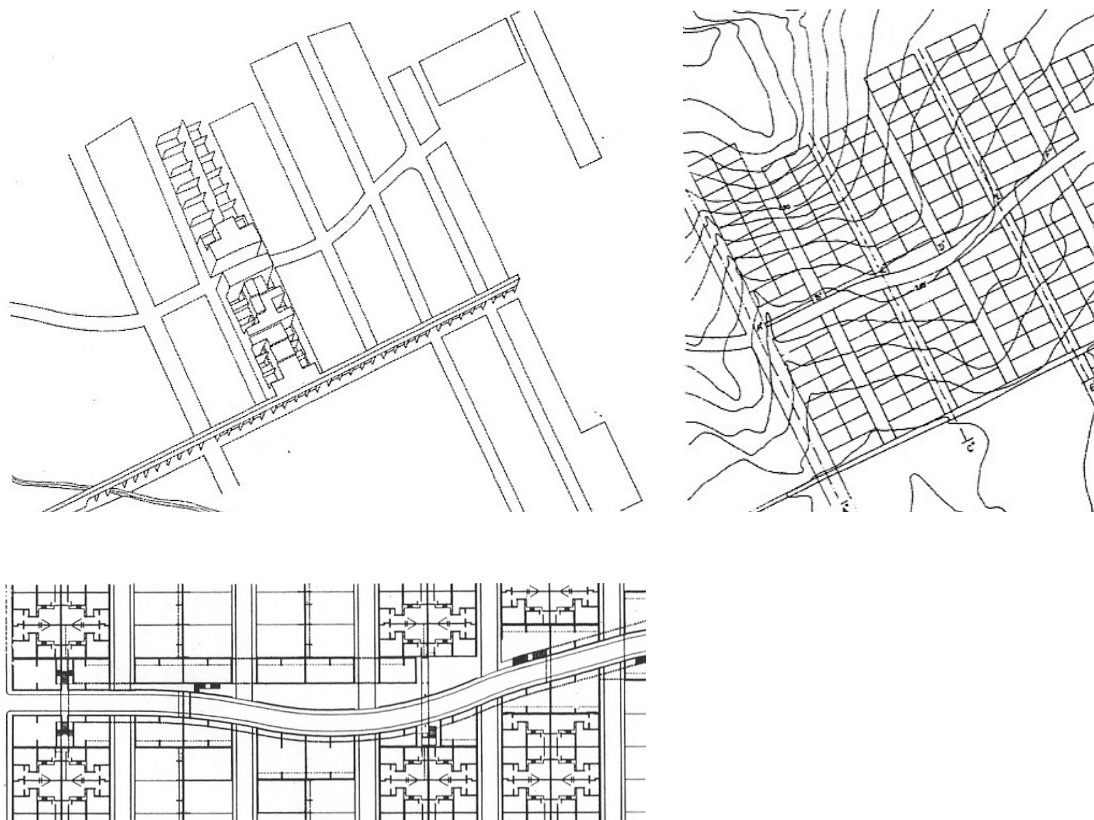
Sector norte, axonometria geral, planta de implantação e planta da rua comercial *Broadway 2*, Malagueira.
